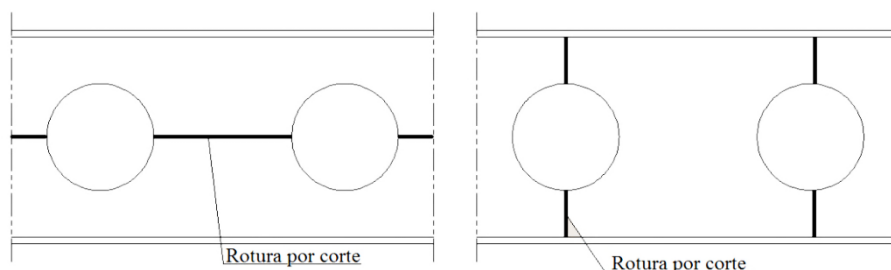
Possíveis roturas por corte na secção perfurada
